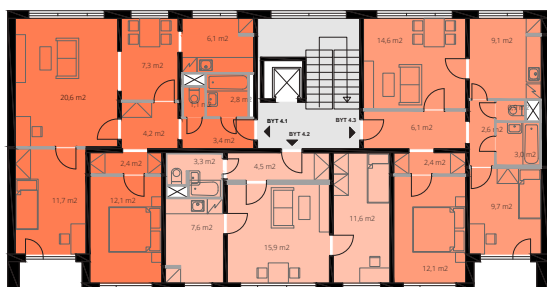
Konstrukční soustava OP 1.11 (Zdroj: panelaky.info)
